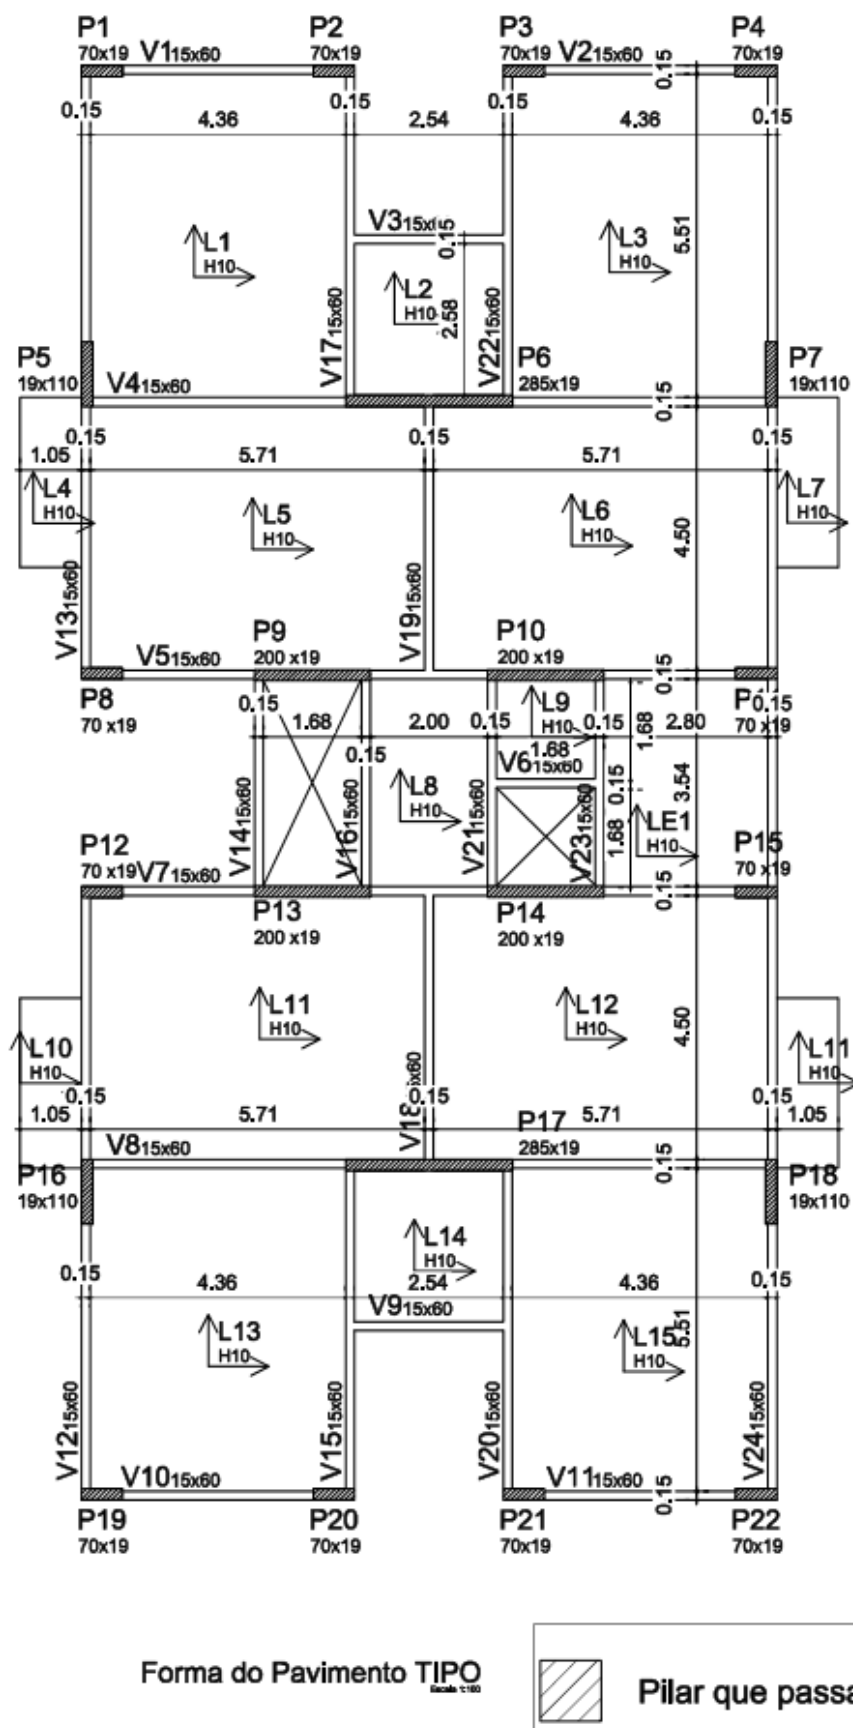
Lançamento dos elementos estruturais nos pavimentos tipo.
